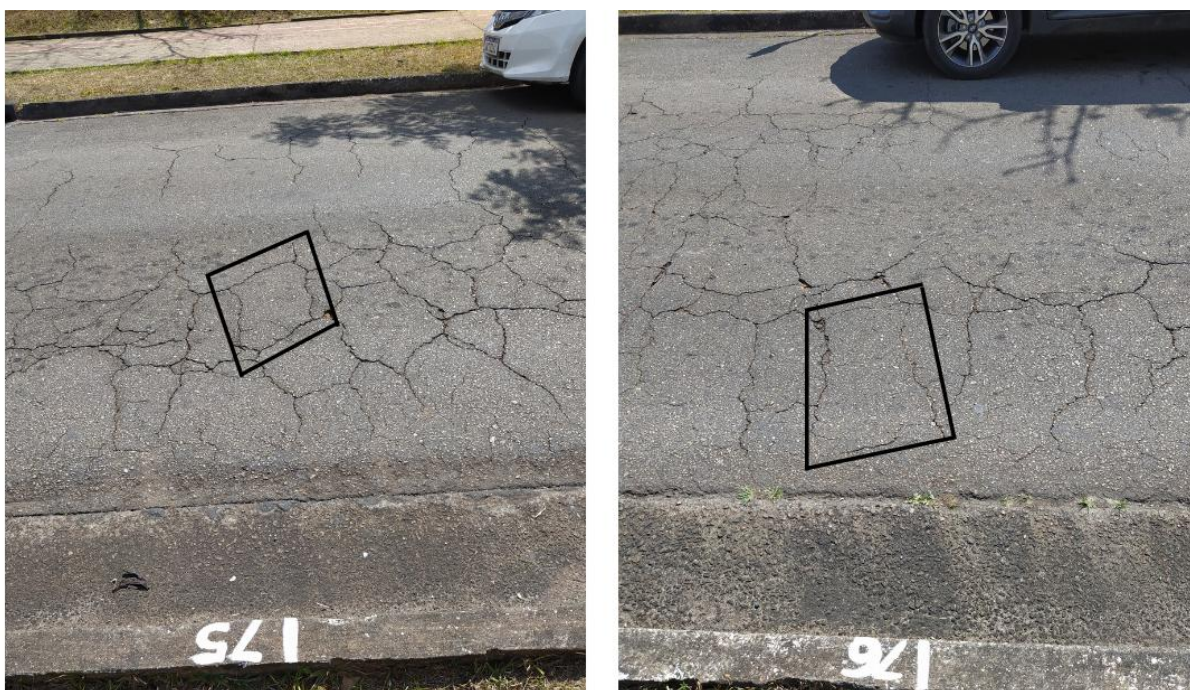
Trincas do tipo "bloco" no pavimento do campus Morro do Cruzeiro. Fonte: Acervo próprio.
